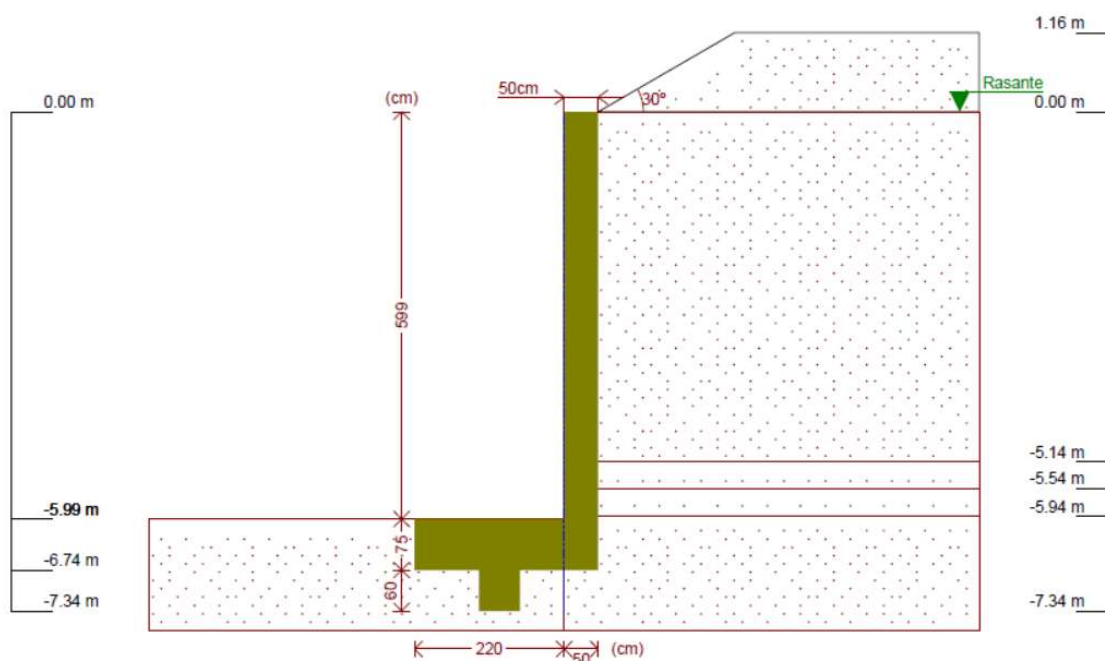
Modelo de muro de hormigón armado 2, para tramos de muro laterales con altura superior a 4,84 m. Fuente: propia (elaborado con CYPE)
